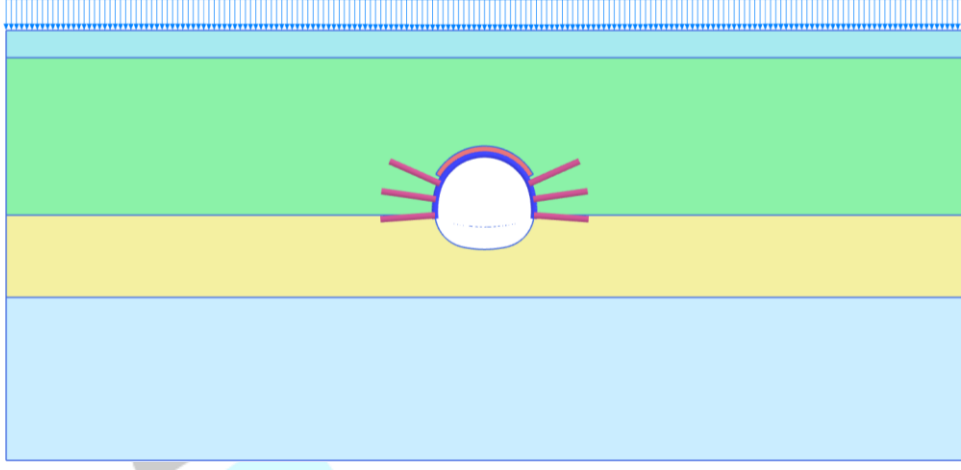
Faz-3: Üst Yarı Kazısının Yapılması
